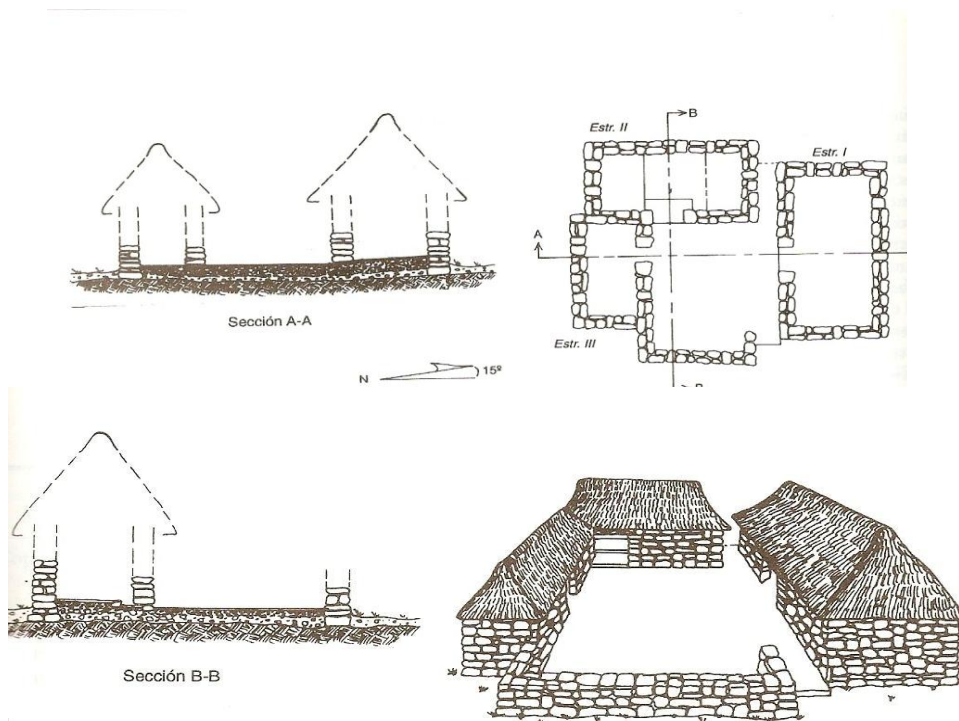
Vistas de corte y plano de típicas casas mayas antiguas, con reconstrucción a la derecha. (Tomado de Sharer, 1998: 451)
